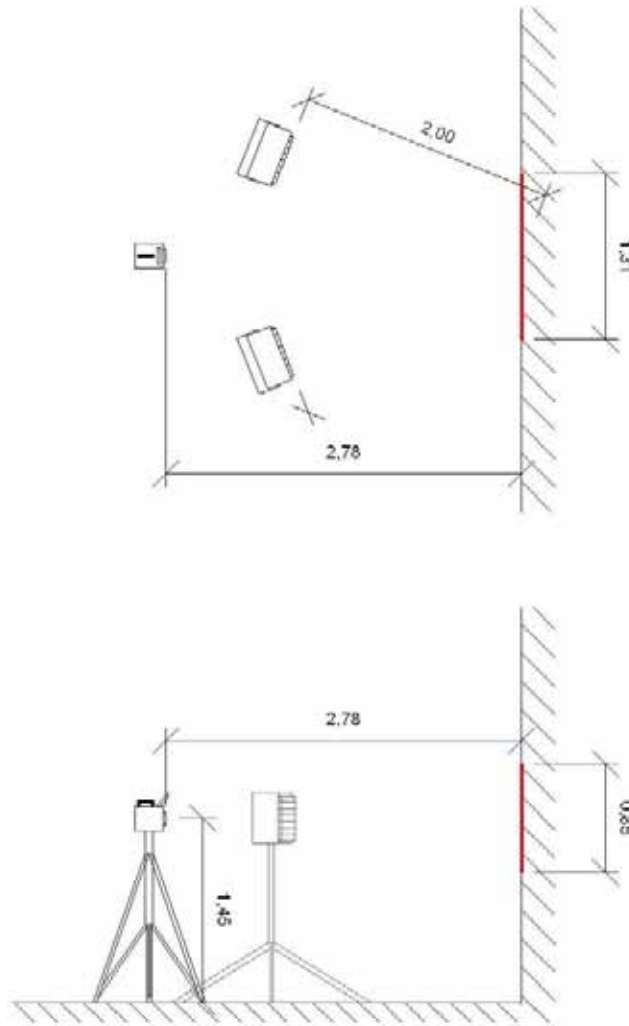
Aufbau des Versuchs an der Probenwand in der Fürstengruft; oben: Grundriss, unten: Ansicht
